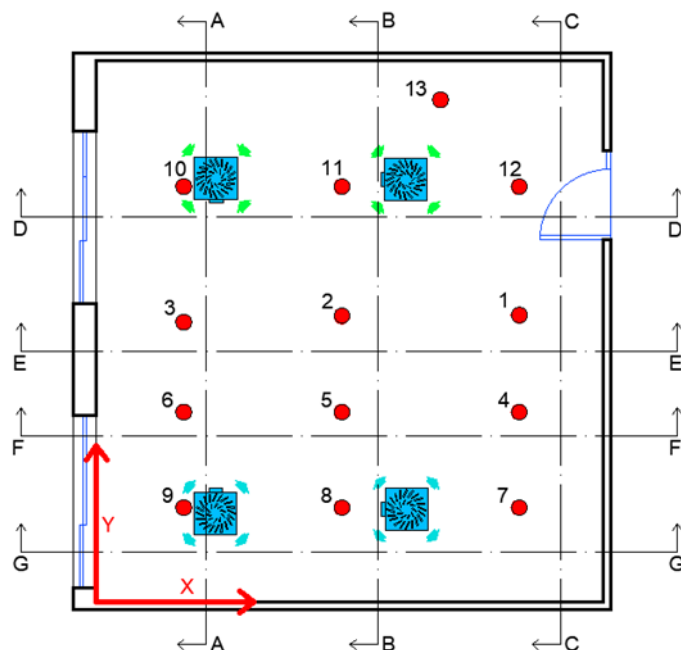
Planimetria con individuazione delle sezioni di riferimento: E-E; F-F
